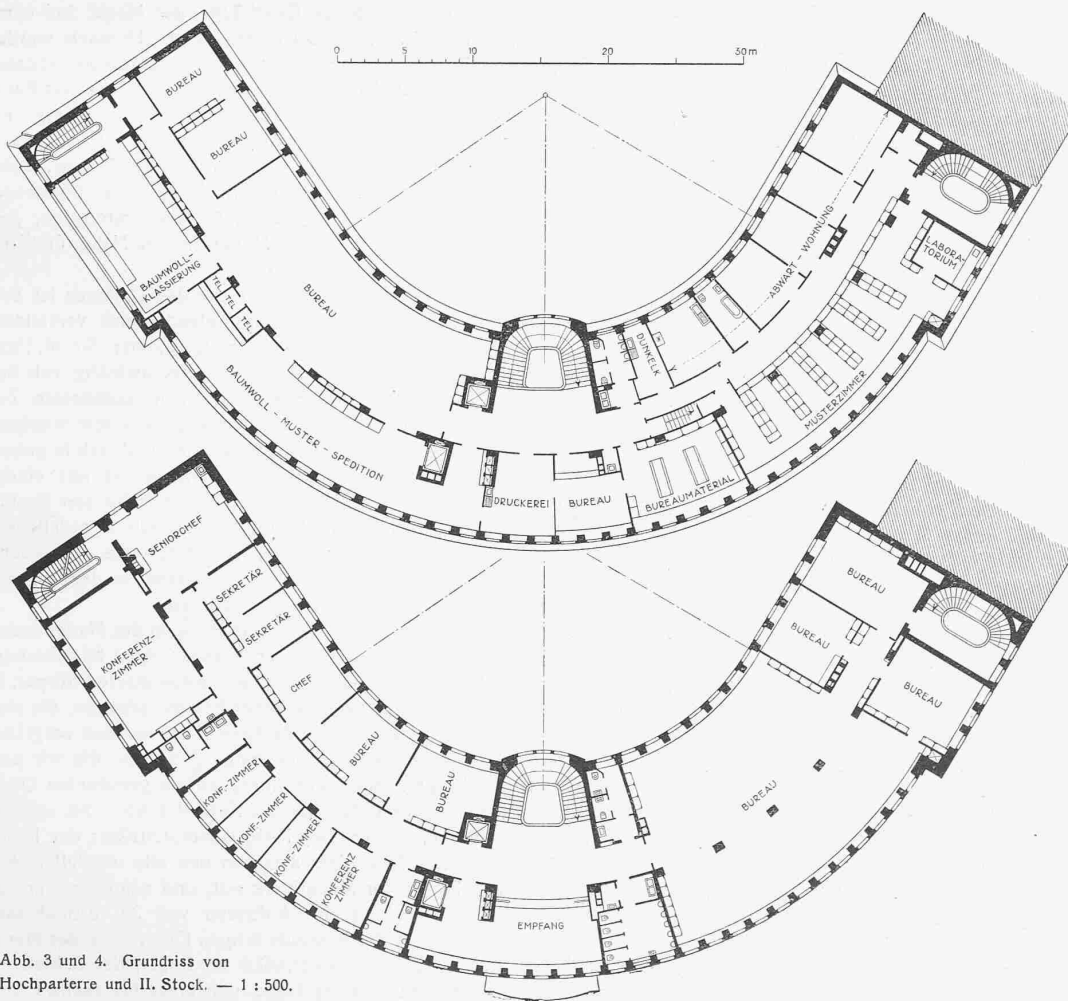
und 4. Grundriss von Hochparterre und II. Stock. — 1 : 500.
